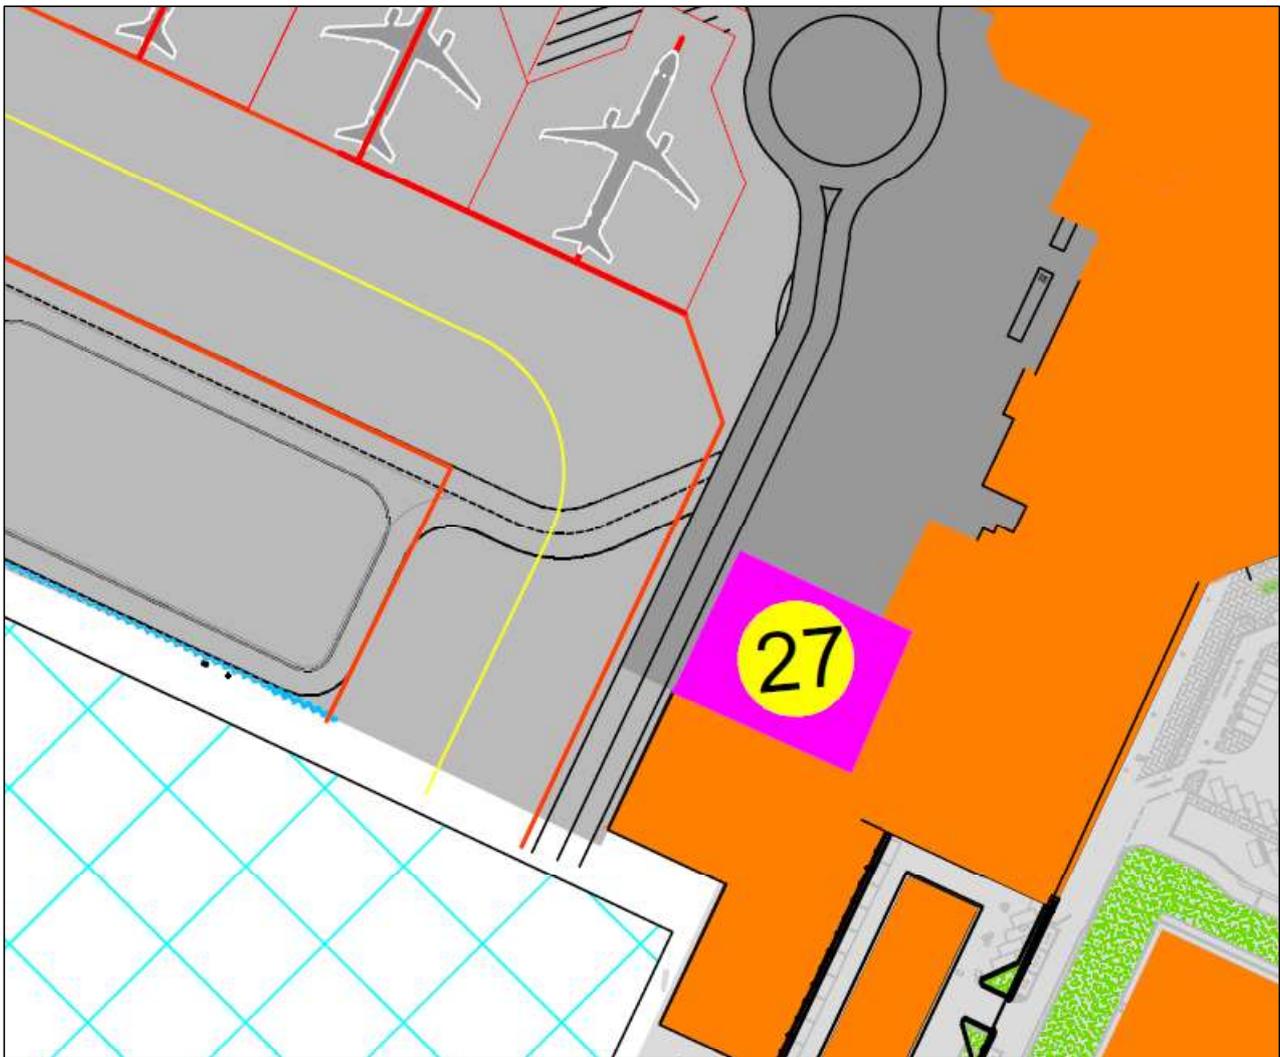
Estratto Master Plan – Ampliamento Edificio BHS
